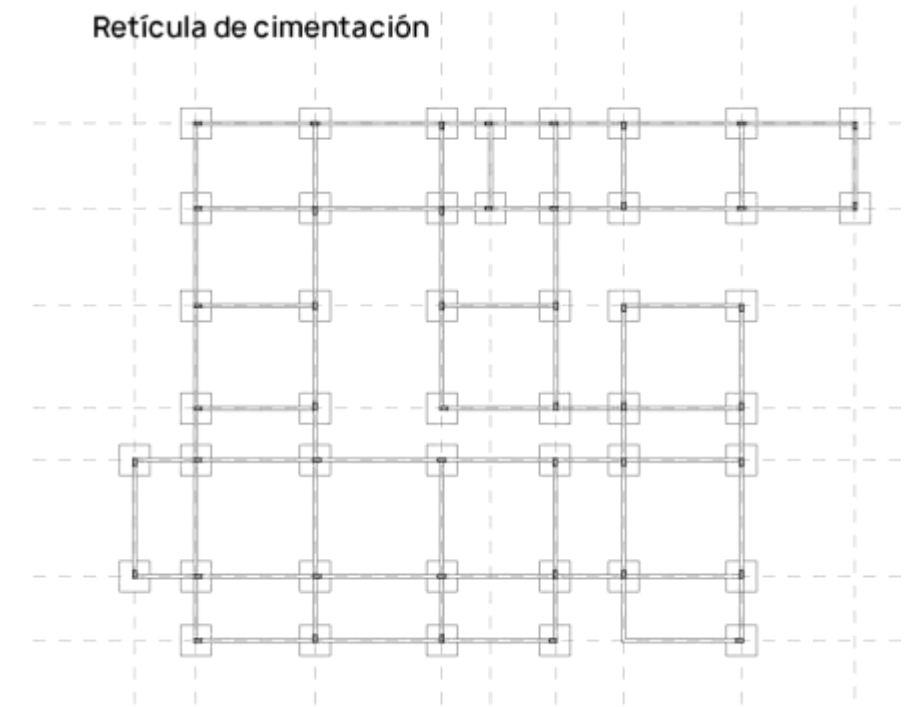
Planta de cimentación. Elaboración: propia. Fuente: propia
